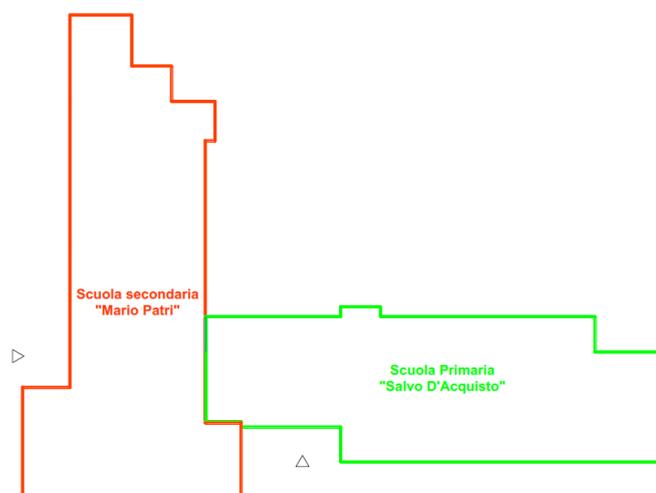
Suddivisione in pianta delle due unità scolastiche
